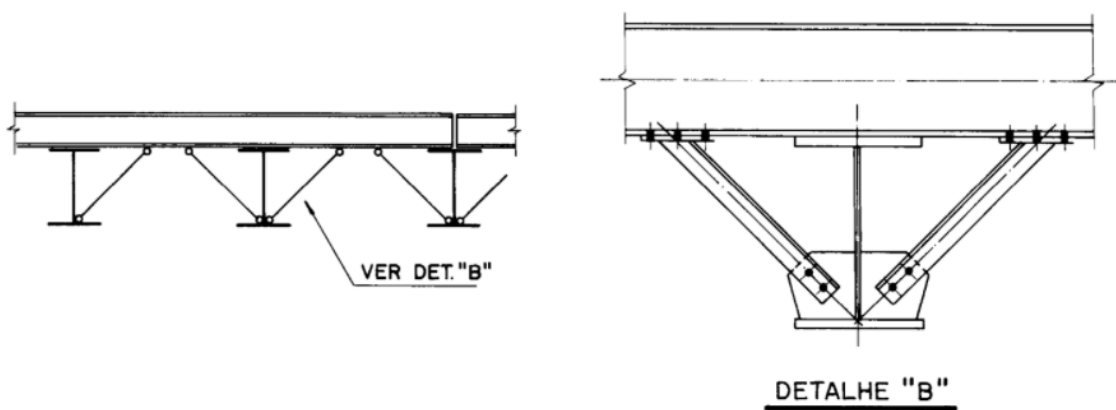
Exemplo de ligação rígida entre viga-pilar
